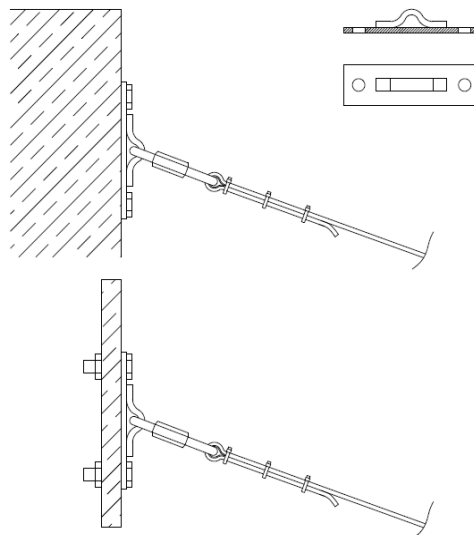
Wandhaken für Betonbecken bzw. Stahlbecken
